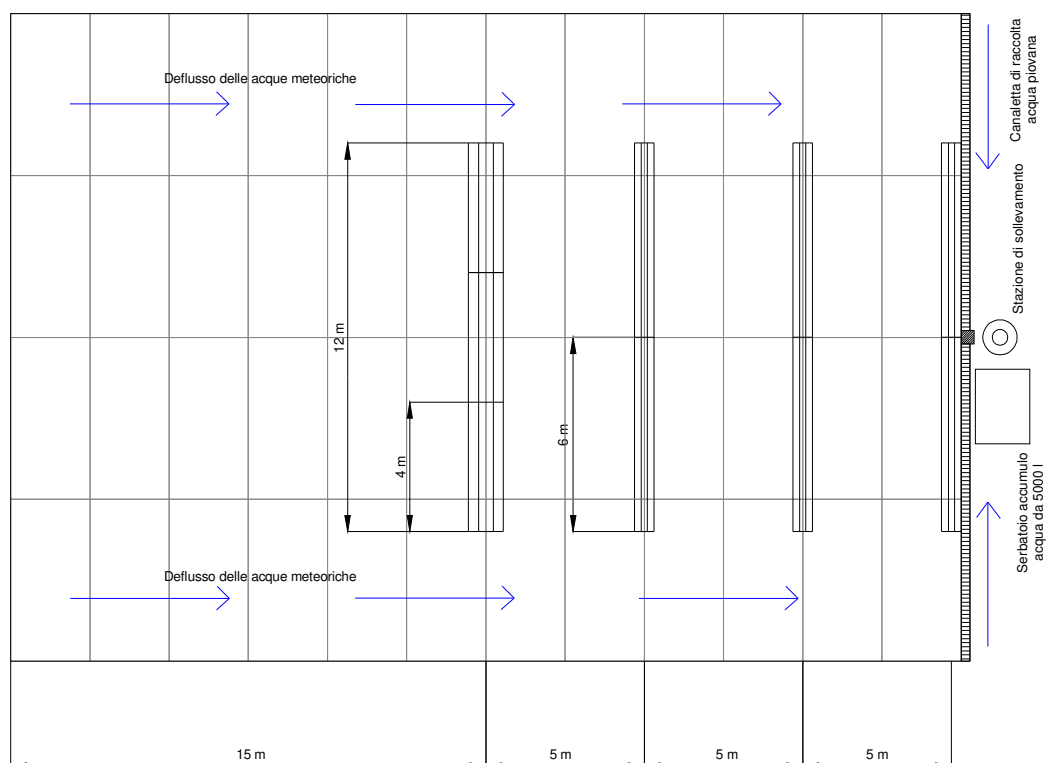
Rappresentazione in pianta dell'area di lavorazione in calcestruzzo e dello schema di deflusso delle acque meteoriche
